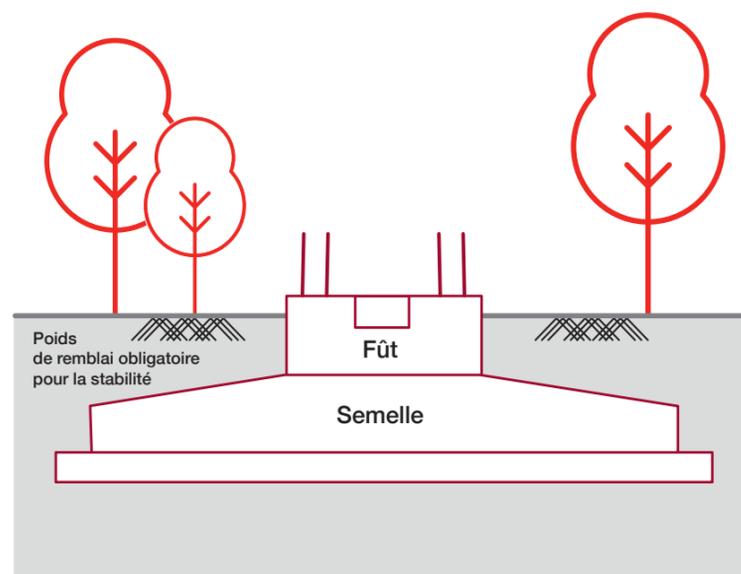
schéma d'une fondation d'éolienne (source : EDPR)
